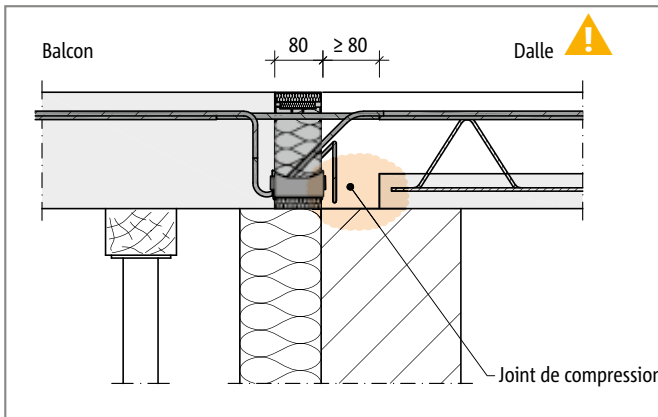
Schöck Isokorb® T Type K-E, K-T : Installation sur plancher en prédalles avec supports muraux, joint de dilatation côté plancher
